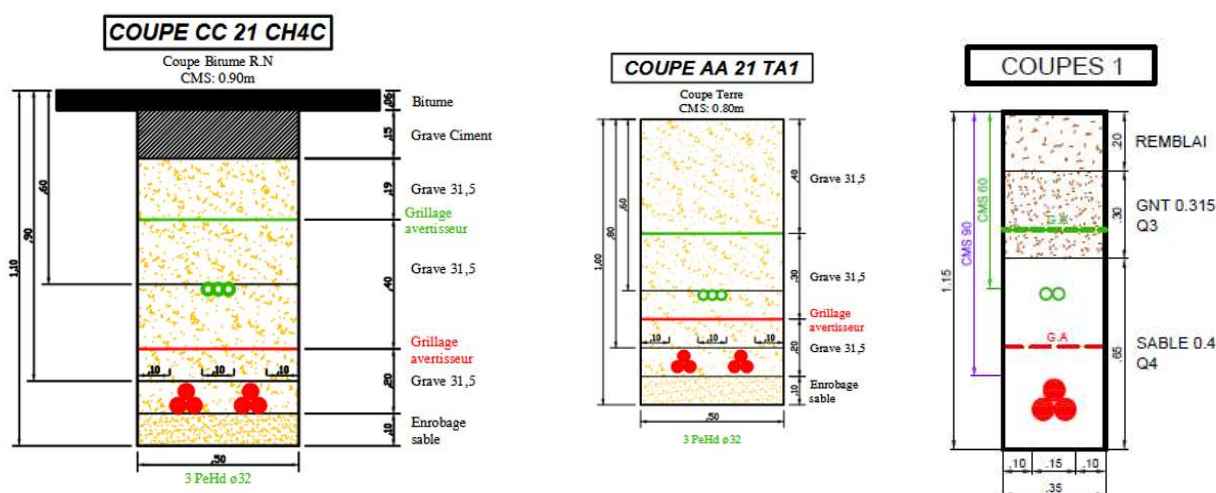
PLAN DE COUPE DES TRANCHEES POUR L'INSTALLATION DES CABLES SOUTERRAINS
